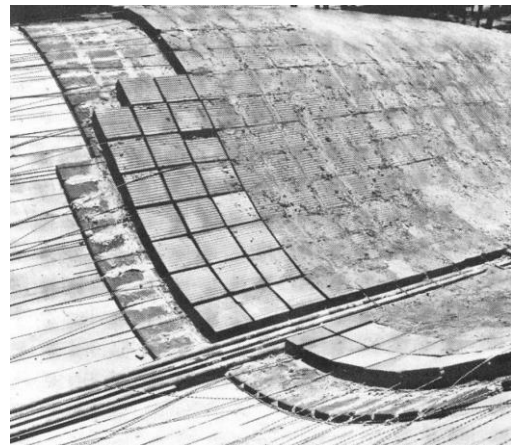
y nº03. Construcción de la cubierta ondulada con las piezas en retícula y el armado homogéneo ([02])
